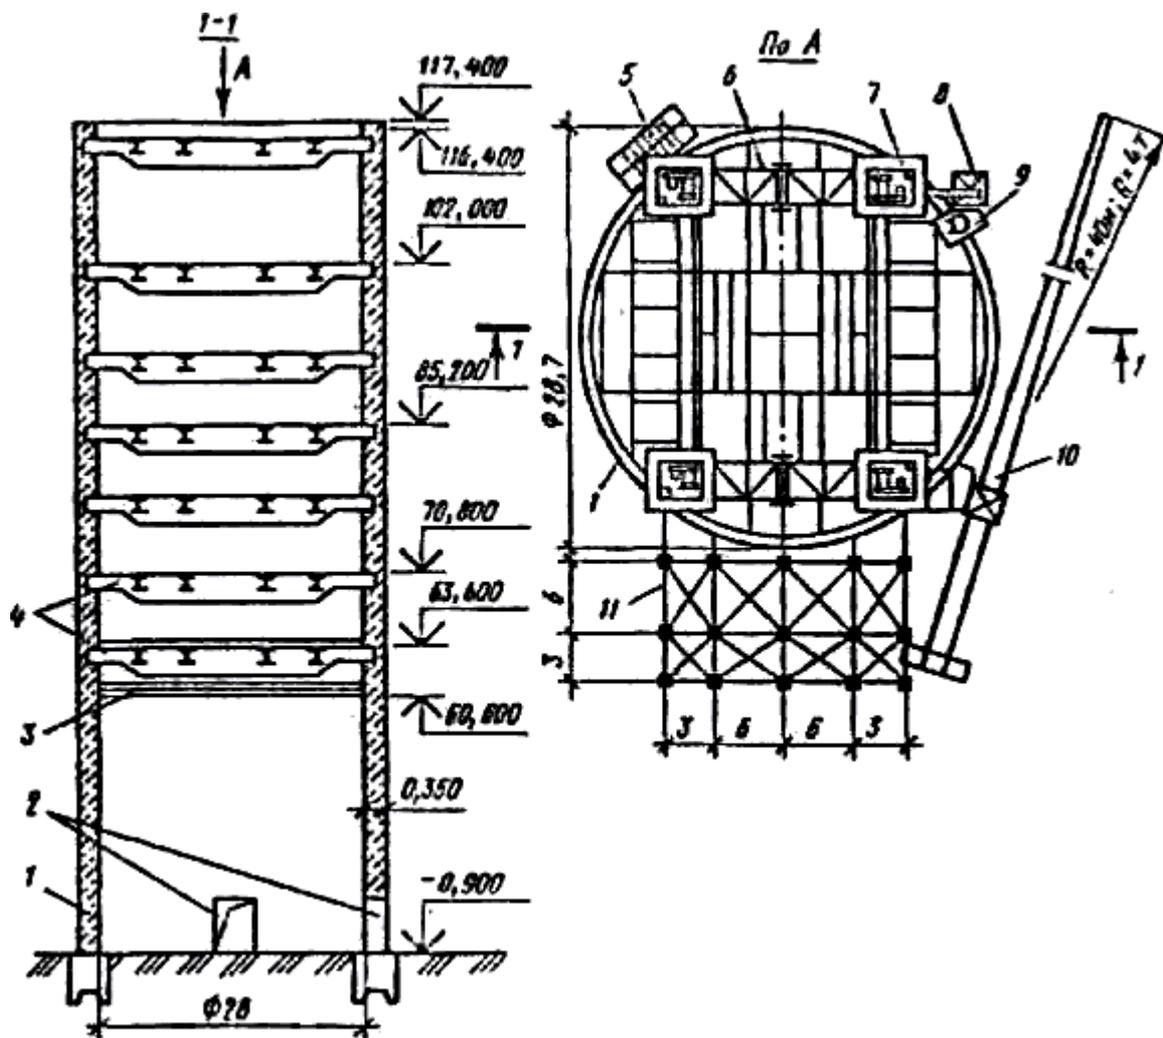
Схемы грануляционной башни и размещения монтажных средств:
